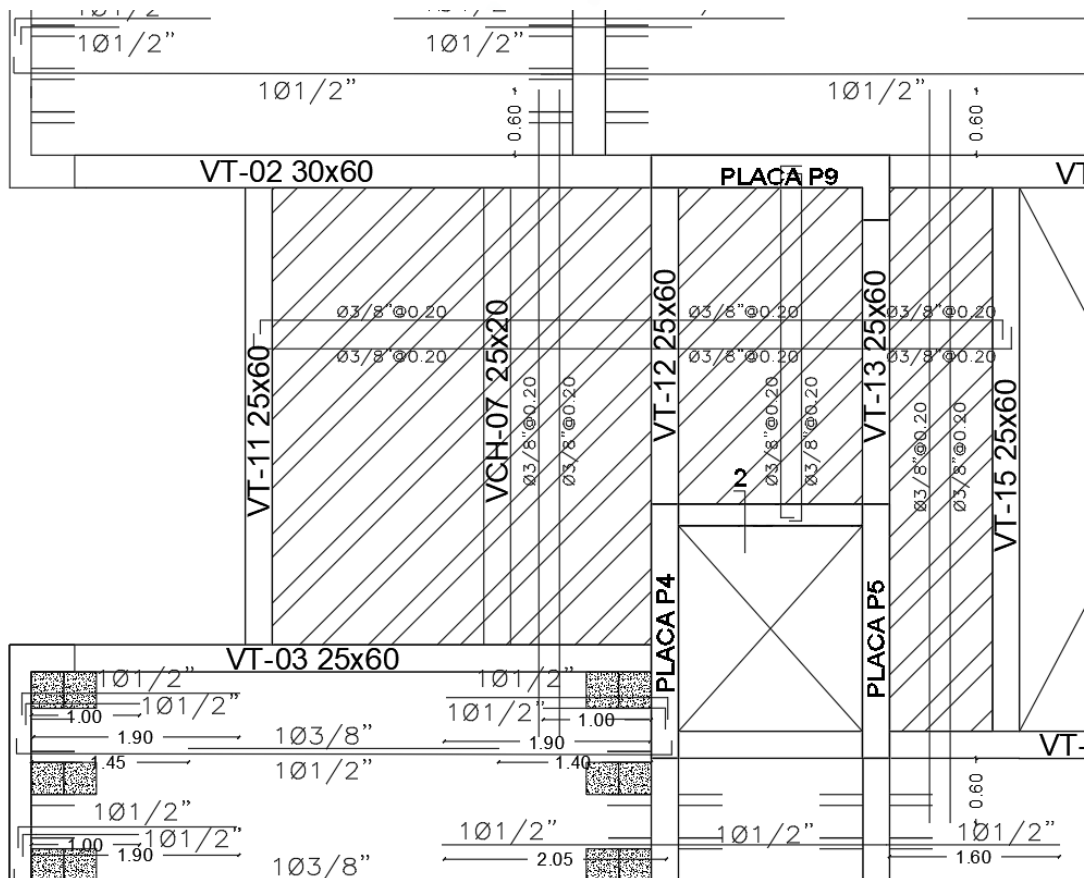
Detalle del refuerzo para la losa maciza ubicada en 1-3/B-C
